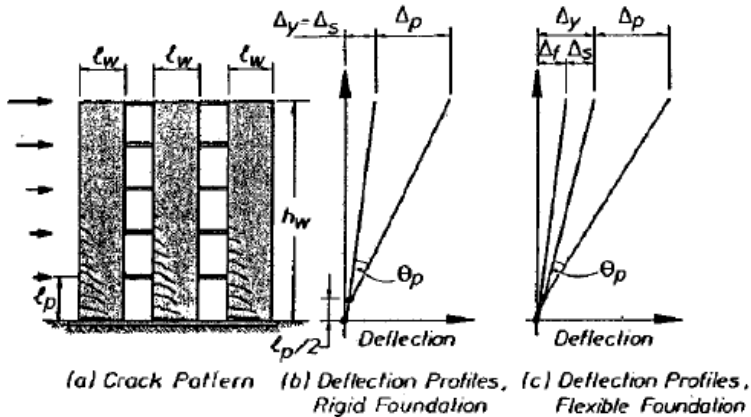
Structură tip pereți necuplați de zidărie: (a) Panou de fisuri; (b) Profilul deformației structurii (pentru fundații rigide); (c) Profilul deformației structurii (pentru fundații flexibile) (Paulay & Priestley, 1992).
